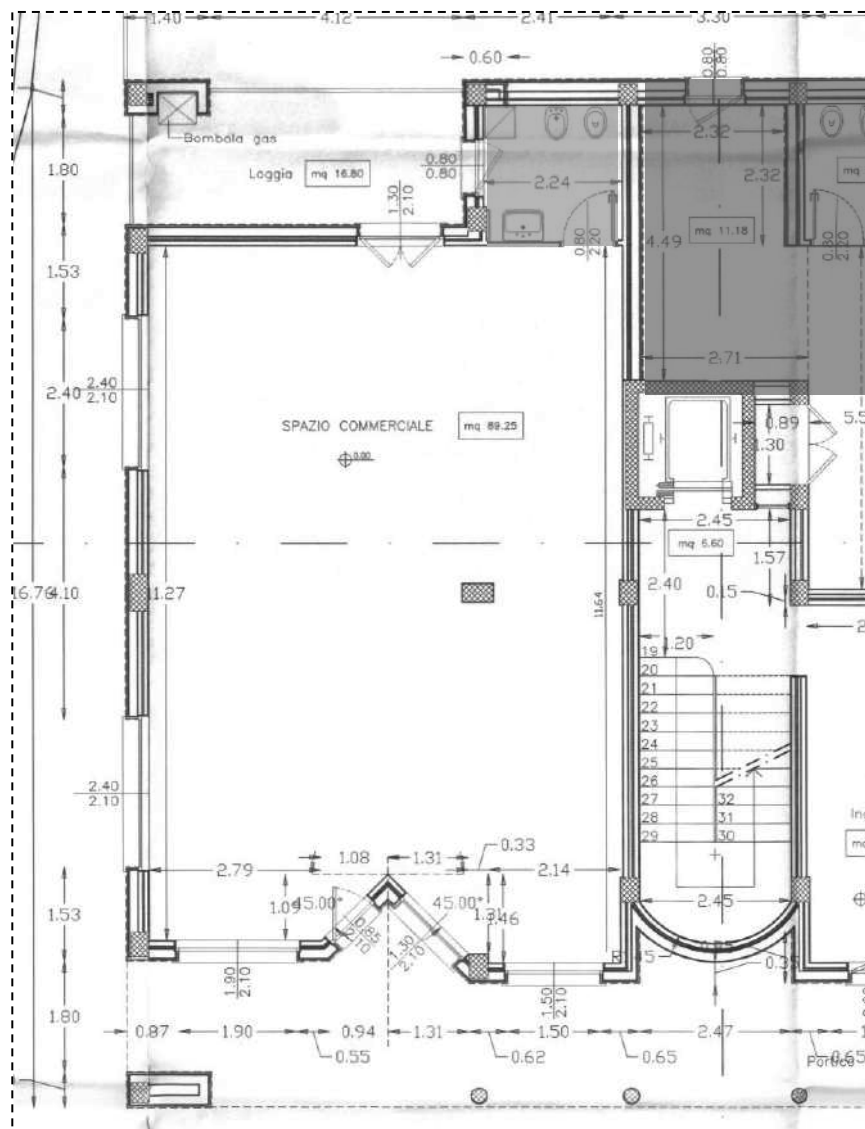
Subalterno 1 – Piano Primo – Planimetria dello stato di progetto con evidenziati gli elementi realizzati in difformità
